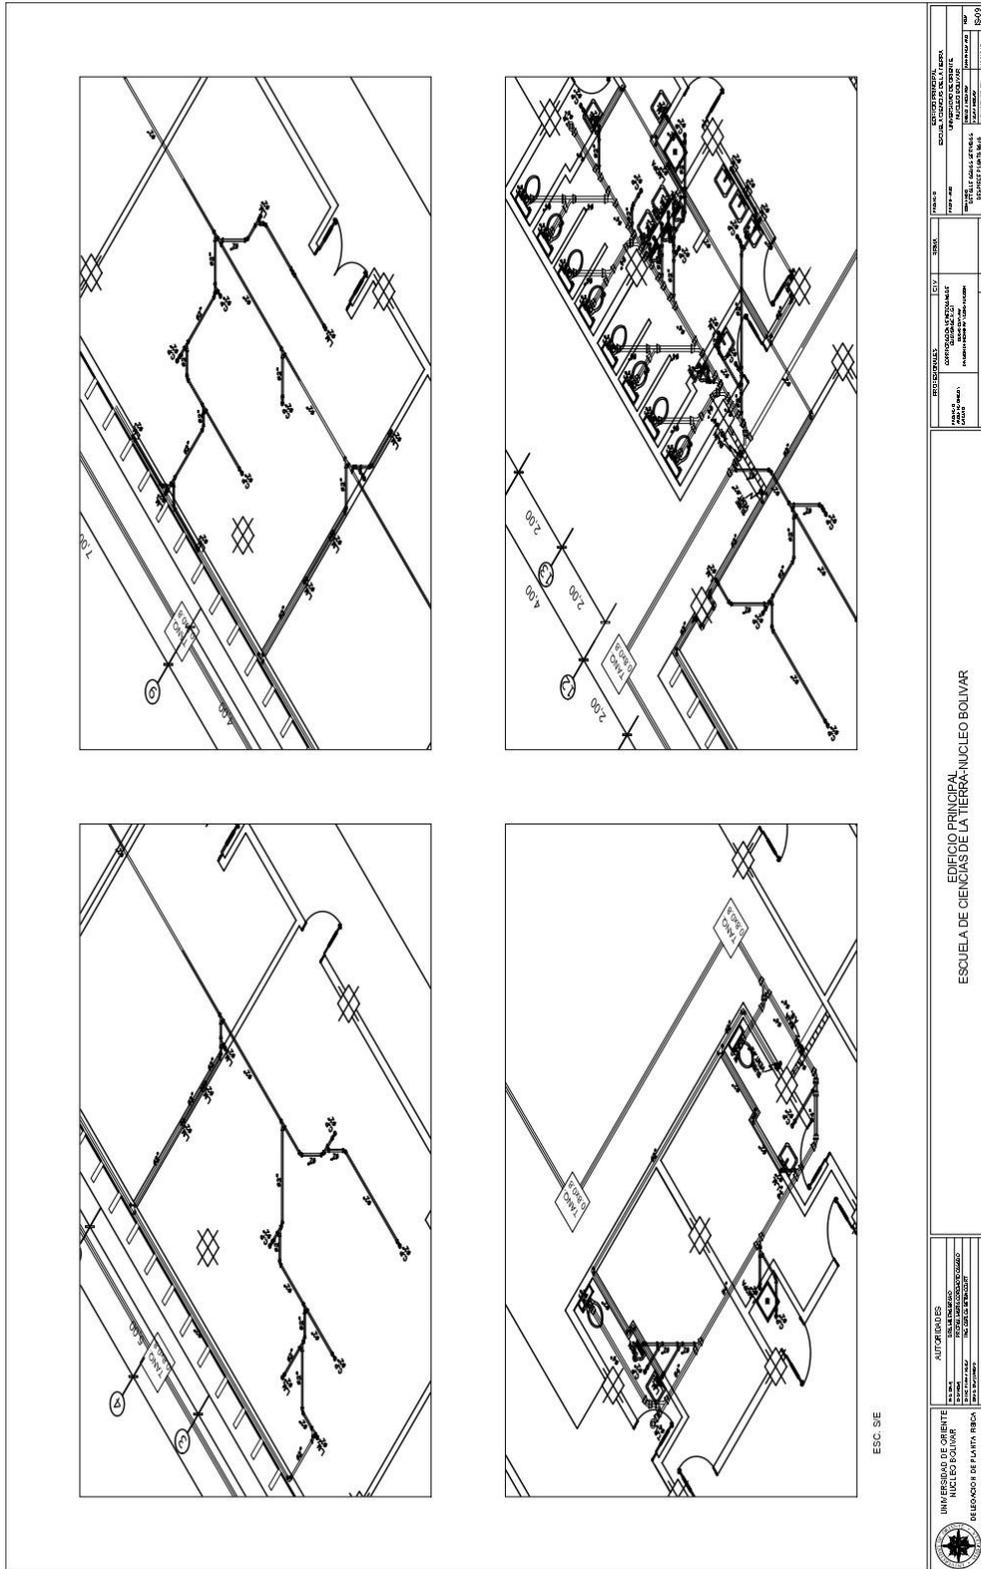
Detalle Aguas Servidas Despiece Planta Baja
